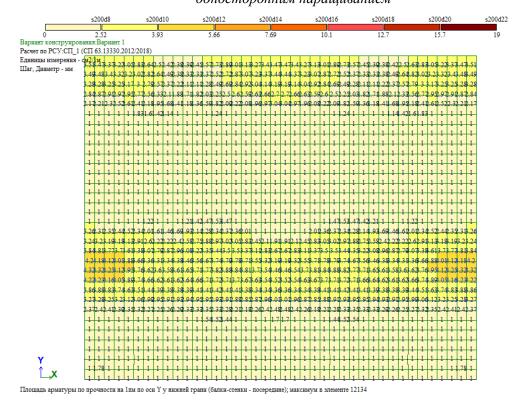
Требуемое нижнее армирование перекрытия по Y, после усиления односторонним наращиванием
